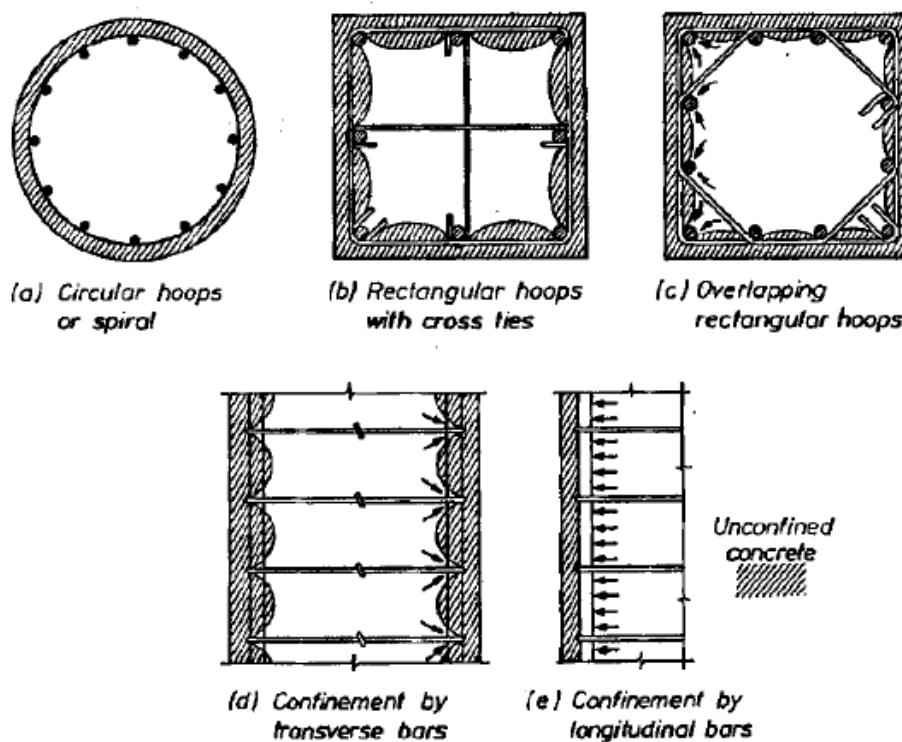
Confinamento de seções de pilar por armaduras transversais e longitudinais
